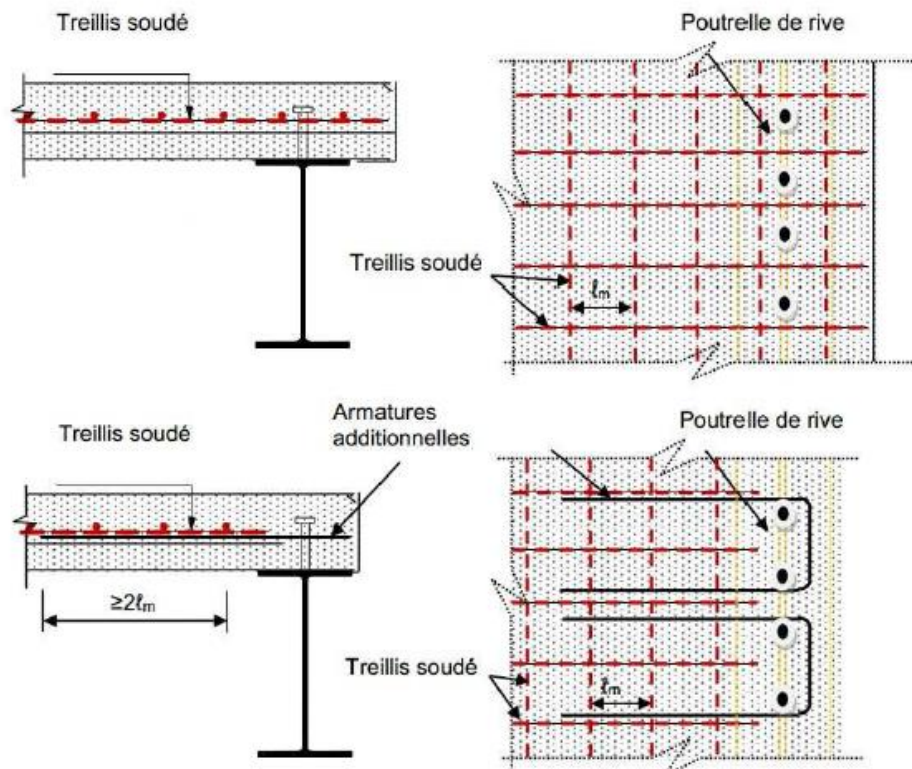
Disposition des armatures additionnelles pour assurer la connexion entre les goujons des poutres et le treillis de la dalle
